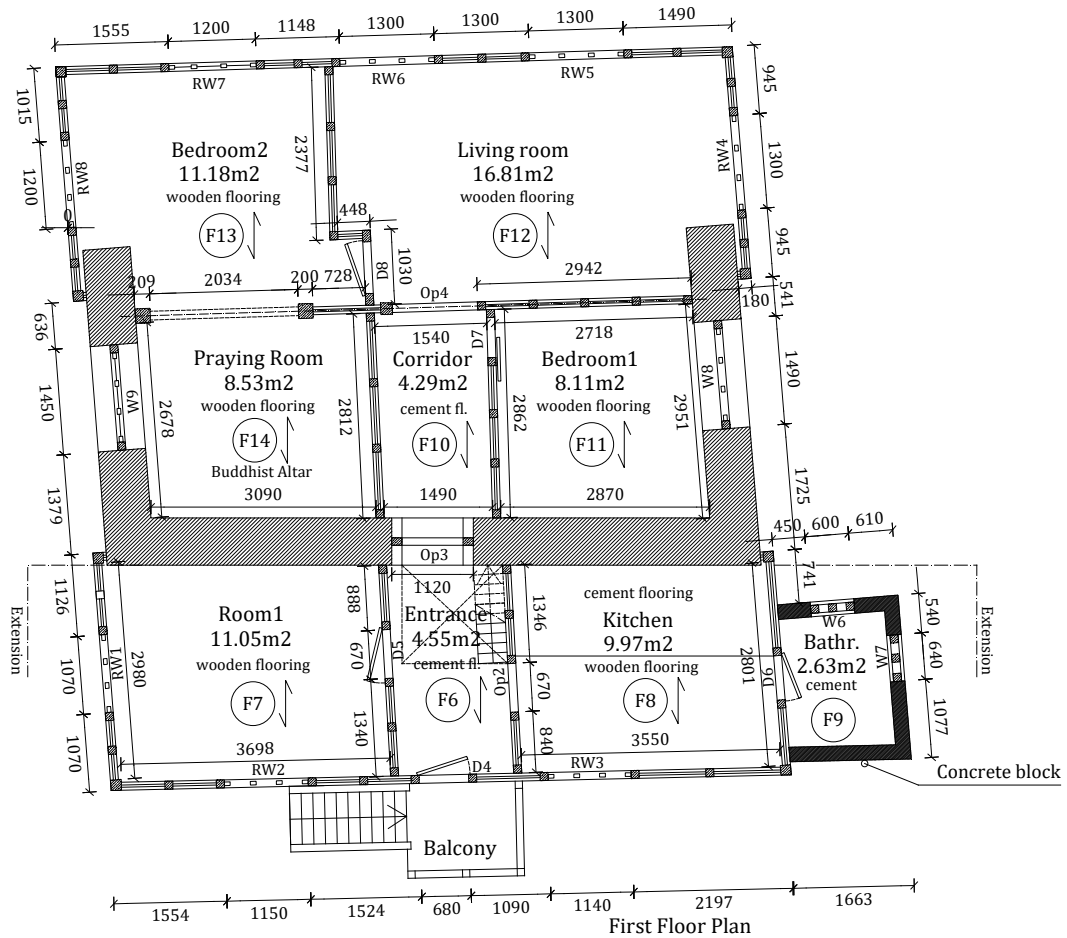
Corte e planta do primeiro piso de um edifício em Tana.
